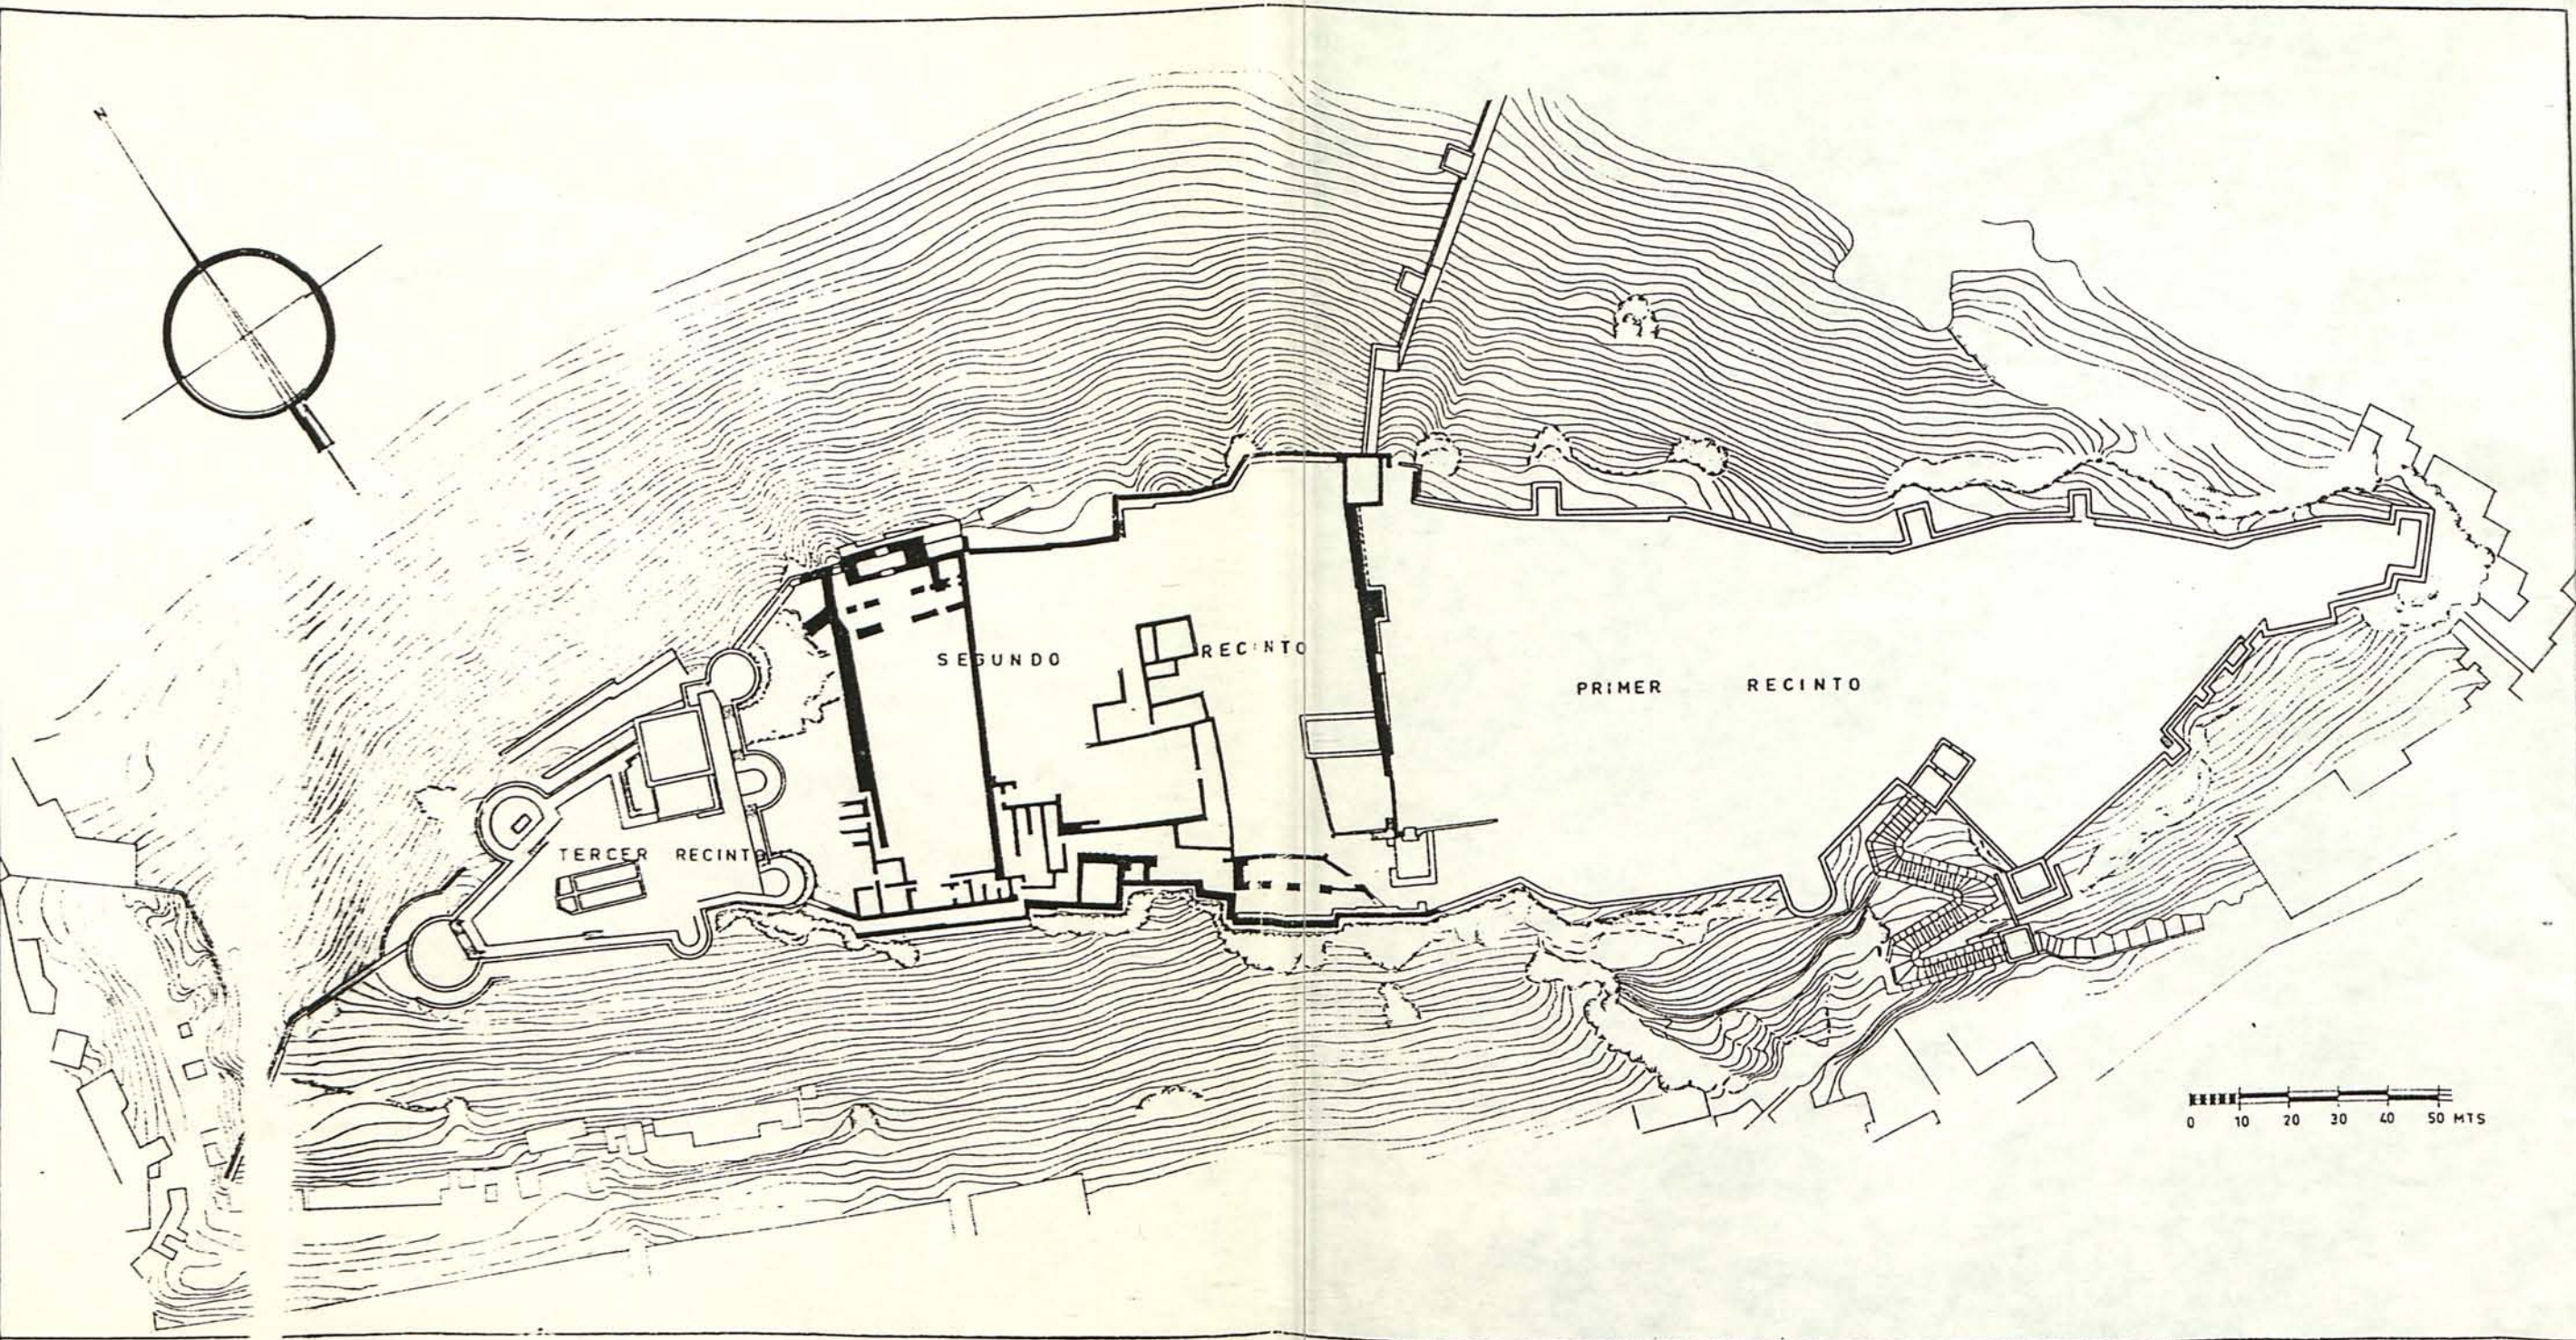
a).—ALCAZABA DE ALMERIA. Plano general.
